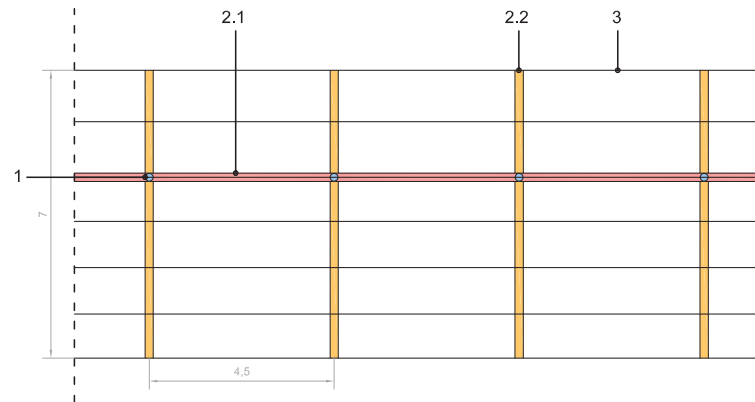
Esquema planta estructura marquesina estación de Segorbe
